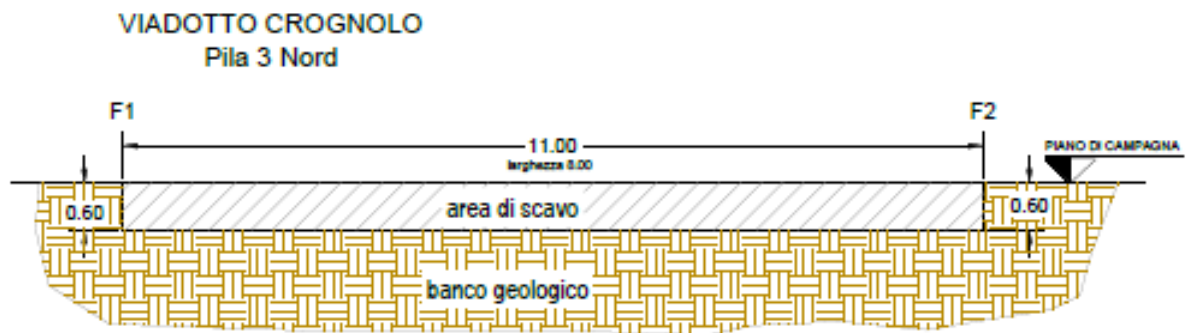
Esempio della sezione di scavo a sezione obbligata posizionato in corrispondenza di una delle spalle del viadotto
